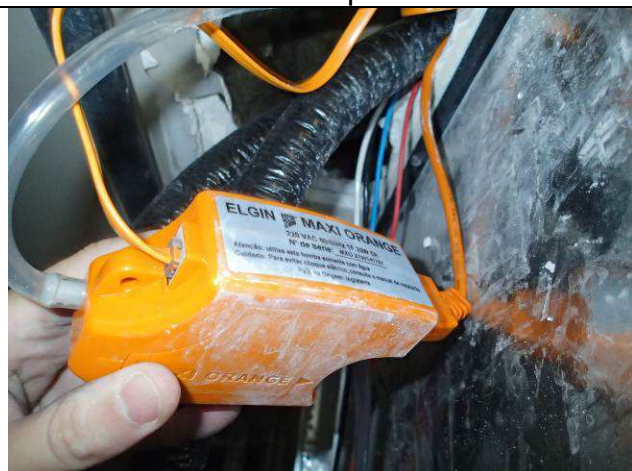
C: Bomba de dreno - evaporadoras - secretaria - 1º pavimento.
